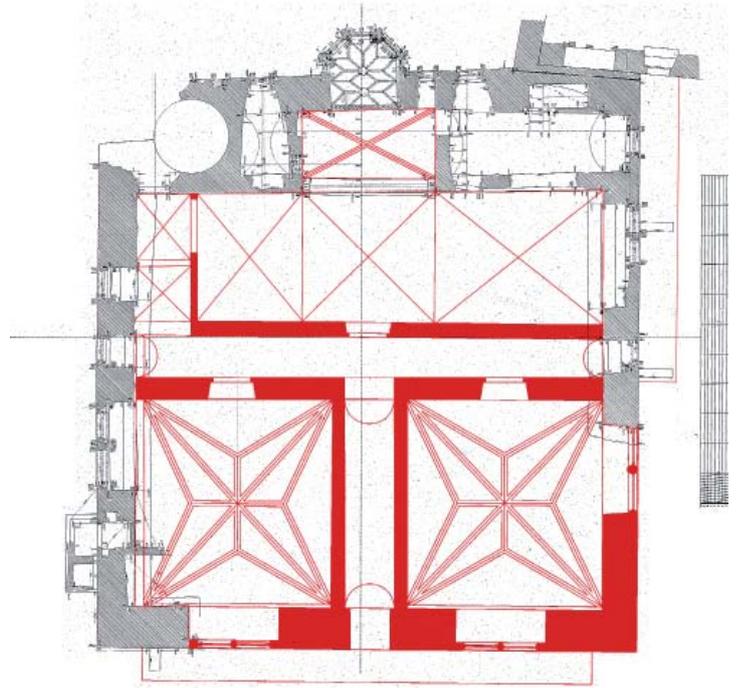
Bibliotheksbau, Grundriss des zweiten Obergeschosses nach der Bauaufnahme von Julius Koch und Fritz Seitz, um 1890 mit ergänzender Eintragung der Gewölbekonstruktion nach den hier vorliegenden Baubefunden, Plan geostet.
